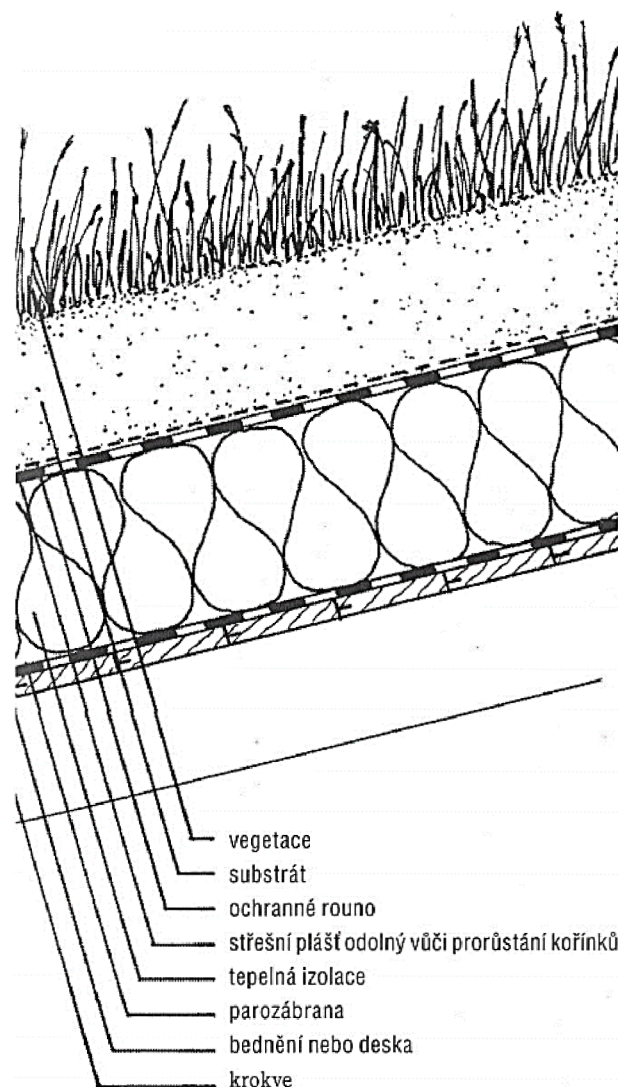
Typická konstrukce studené střechy s ozeleněním [5]
